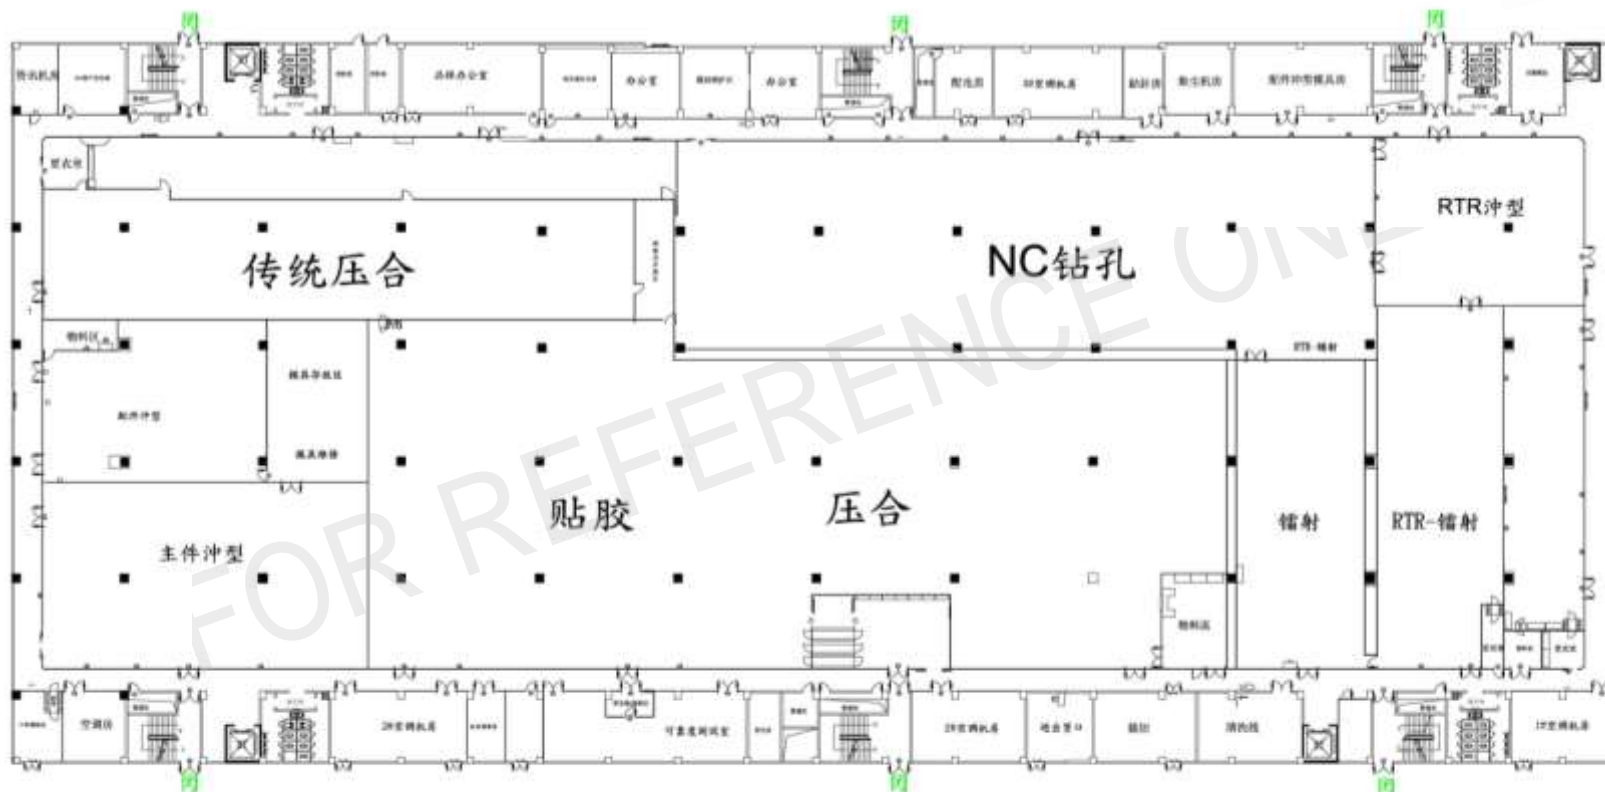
鹏鼎公司 A1 栋厂房一层车间平面布置图
